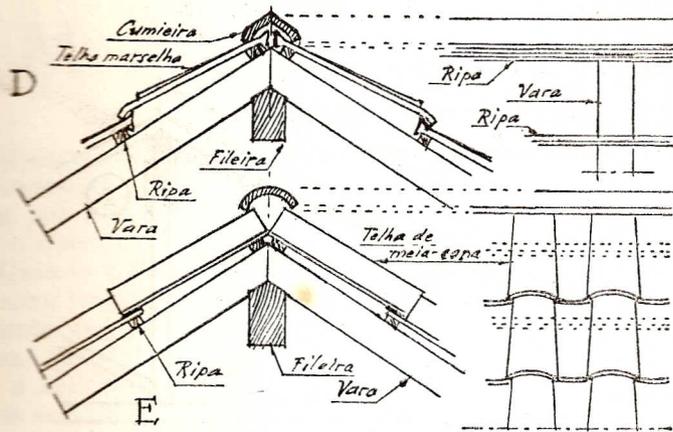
PORMENORES DO MADEIRAMENTO VULGAR
